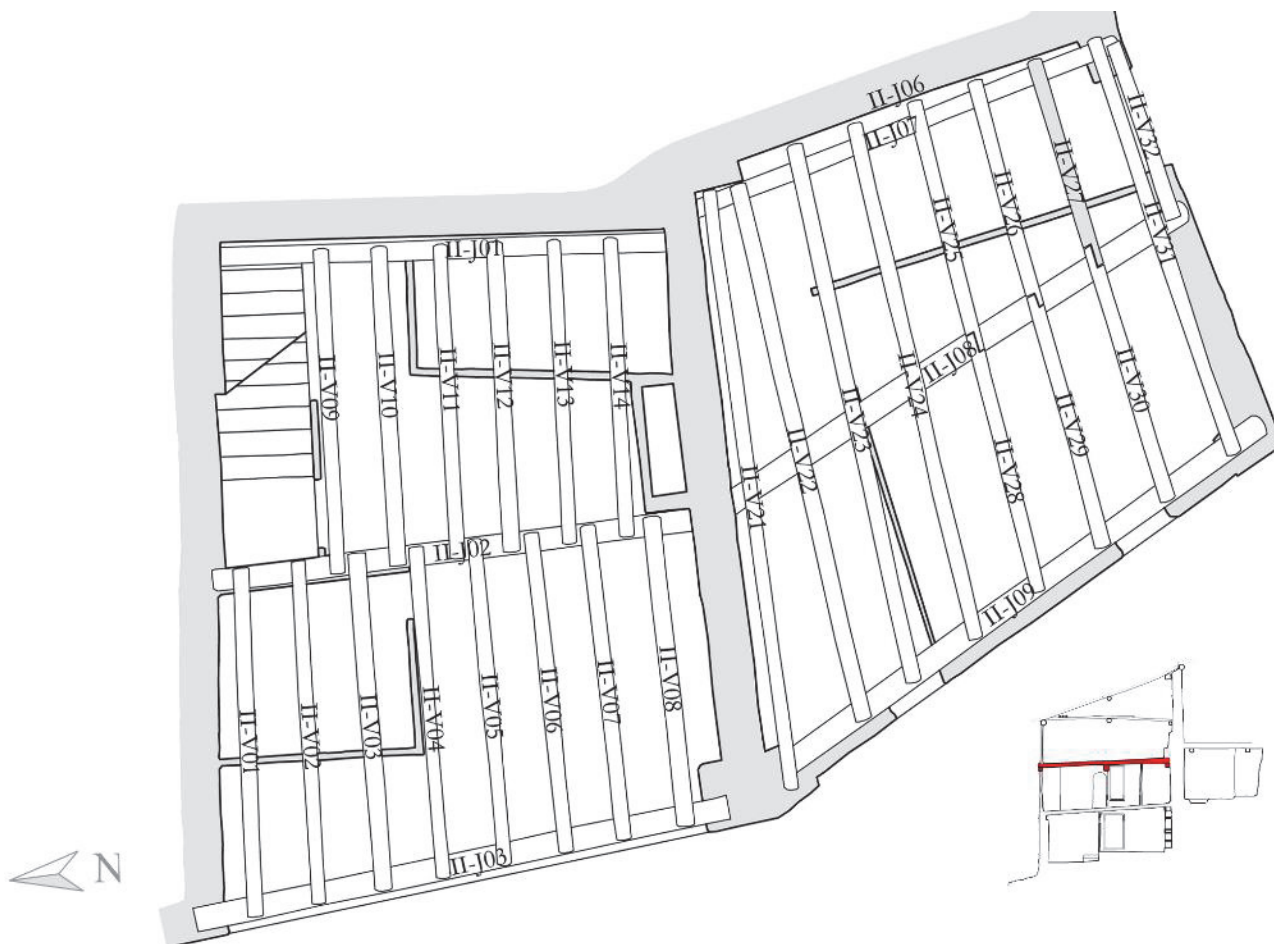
Plano de la estructura del forjado de la primera planta en el edificio estudiado, aldea de Sesga, en el Rincón de Ademuz, Valencia.
